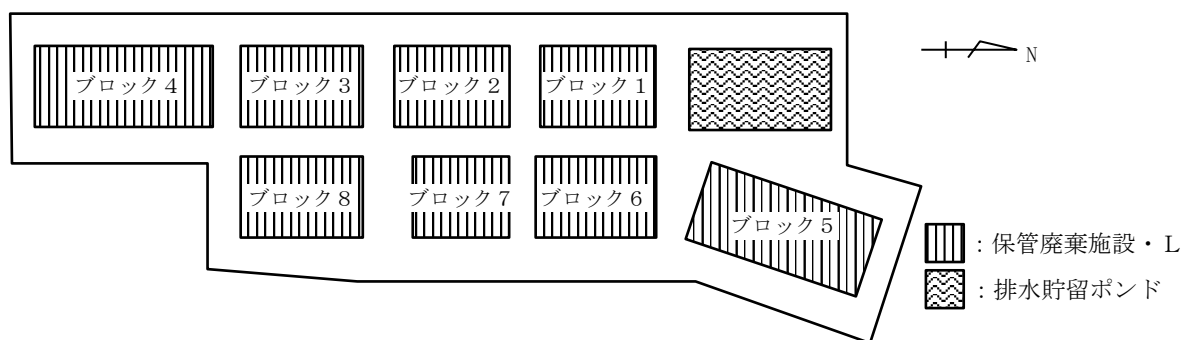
排水貯留pond及び保管廃棄施設・L配置図
